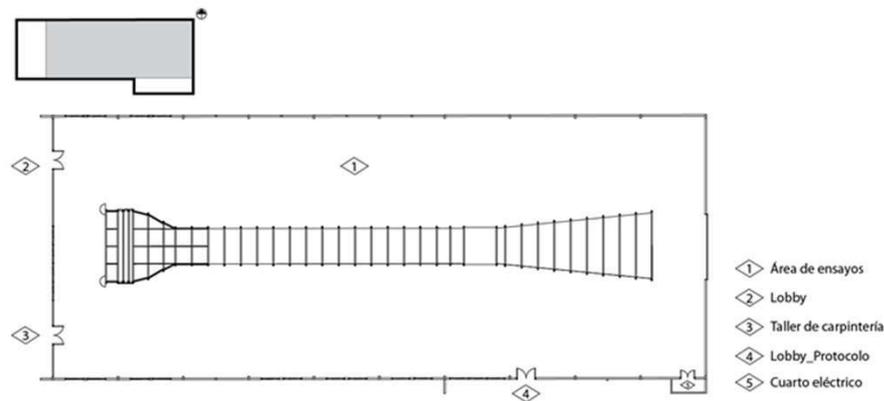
Distribución en planta del proyecto de nave para el túnel de viento. Área de ensayos.
